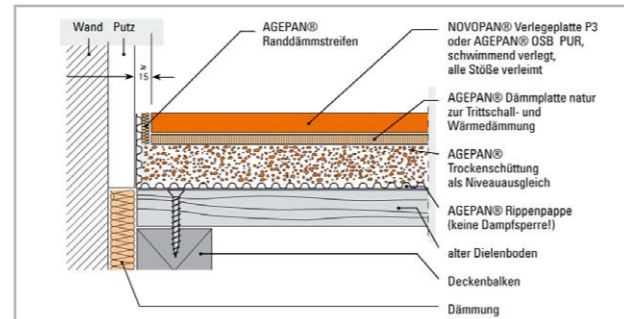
Das schwimmende Verlegen auf Holzbalkendecken mit AGEPAN® Trockenschüttung.
